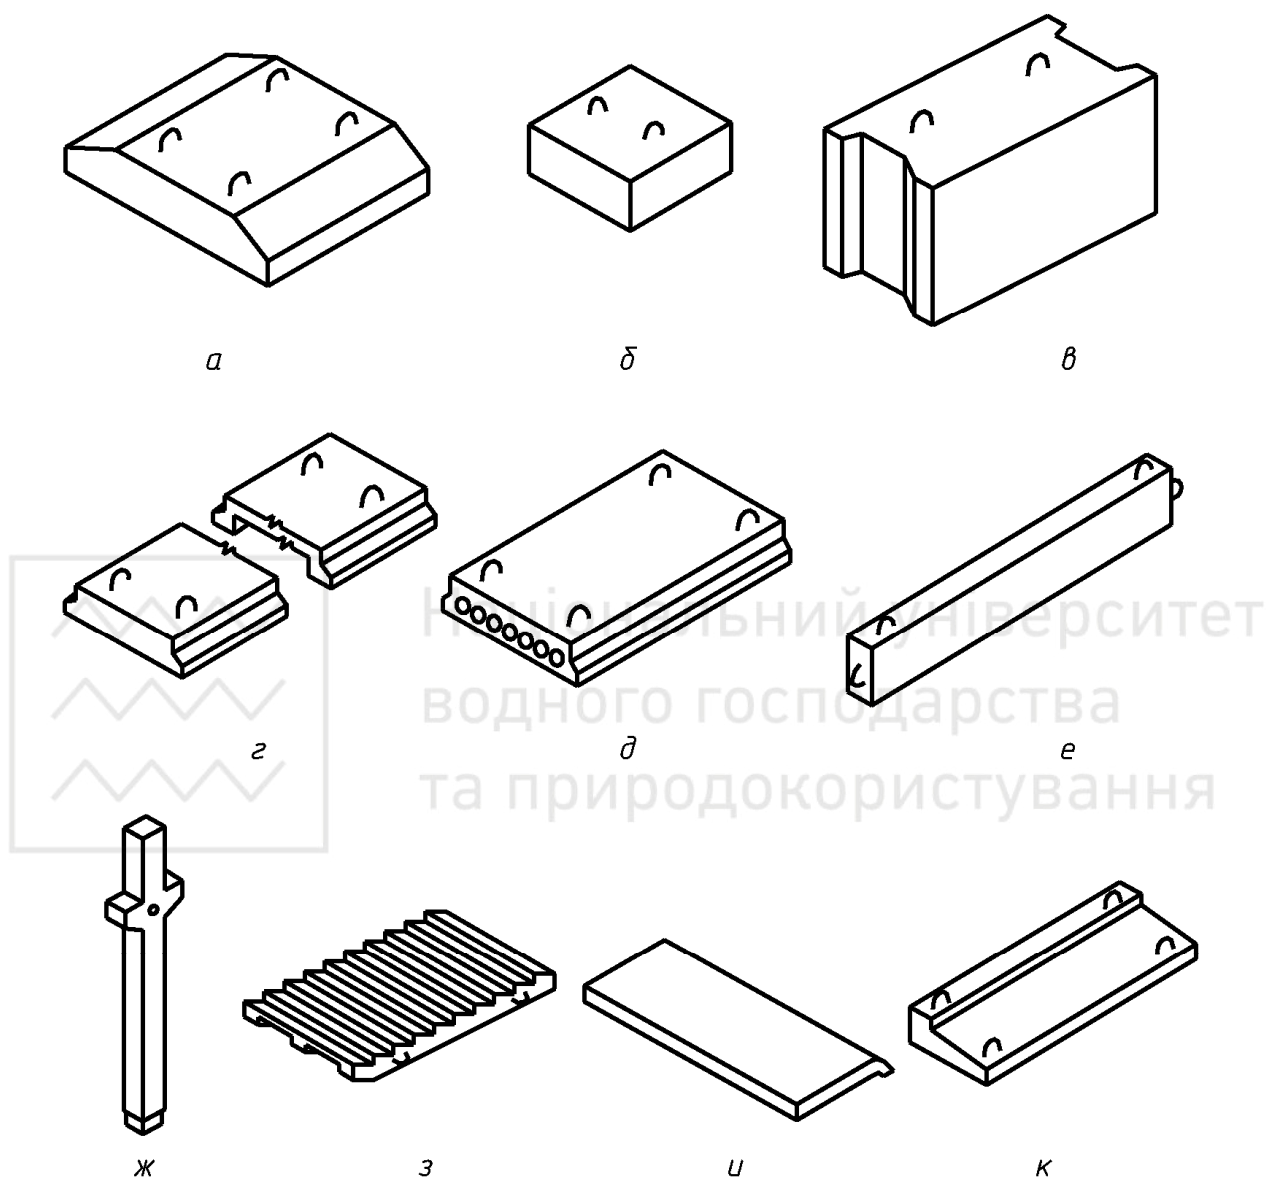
Типові залізобетонні конструкції (елементи): а - фундаментна плита; б, в – блоки стін підвалу; г -ребриста плита перекриття; д - плита перекриття з круглими пустотами; е - ригель або прогін; ж - колона; з - сходовий марш; и - проступ; к - балконна плита
